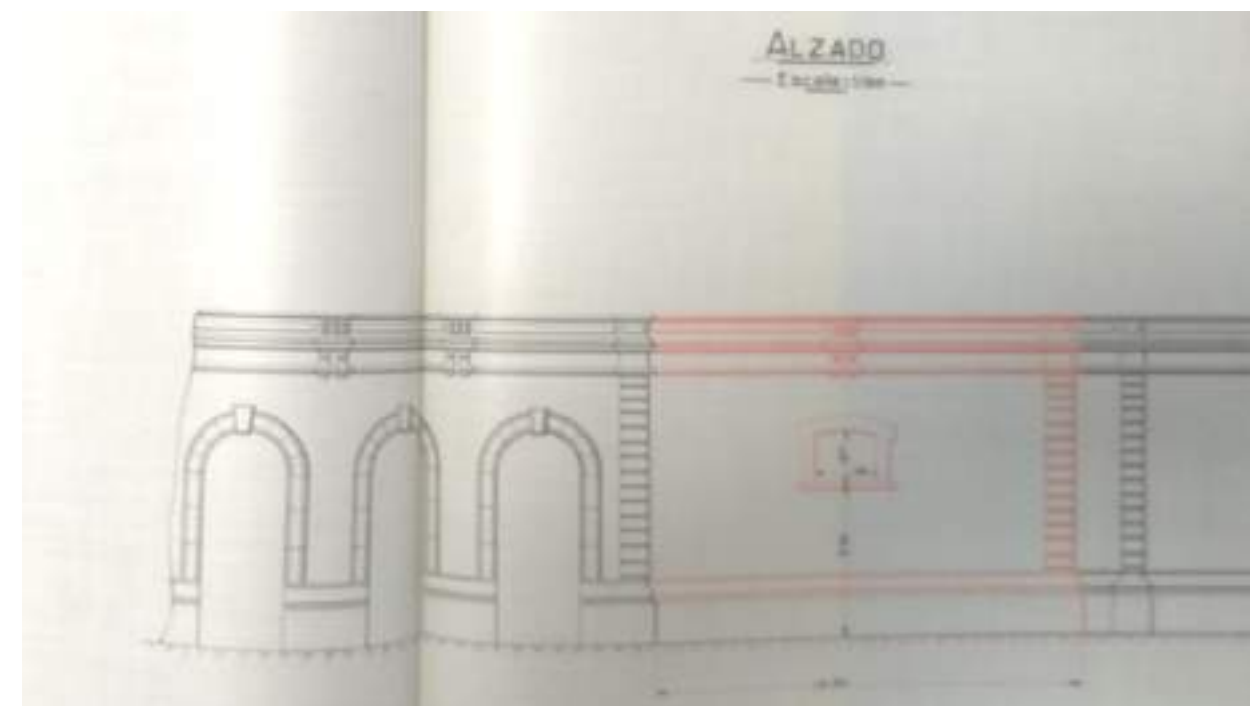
Alzado en el que se destaca la nueva construcción con tinta roja. Alzado (Escala 1:100), 26 de julio de 1930, en “Pabellón con cajonería para el personal de trenes”. AHF-MFM., B-0027-006 14-16.
